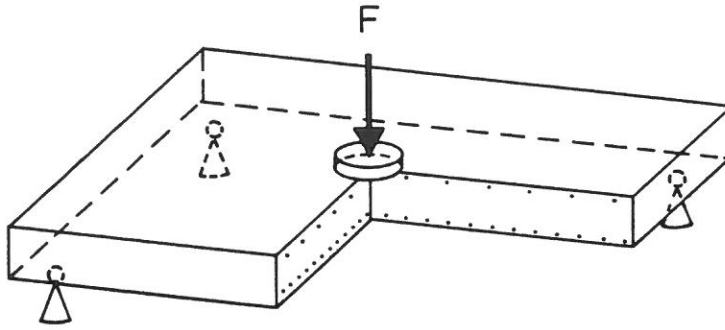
Stahlbetonplatte mit Auflagerung an den vier Ecken und mittig angreifender Belastung (Schnitt-Darstellung)
